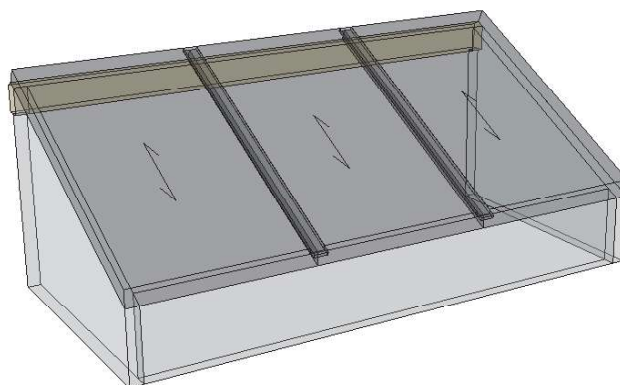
Exemple de jointement au faitage sur appui simple
